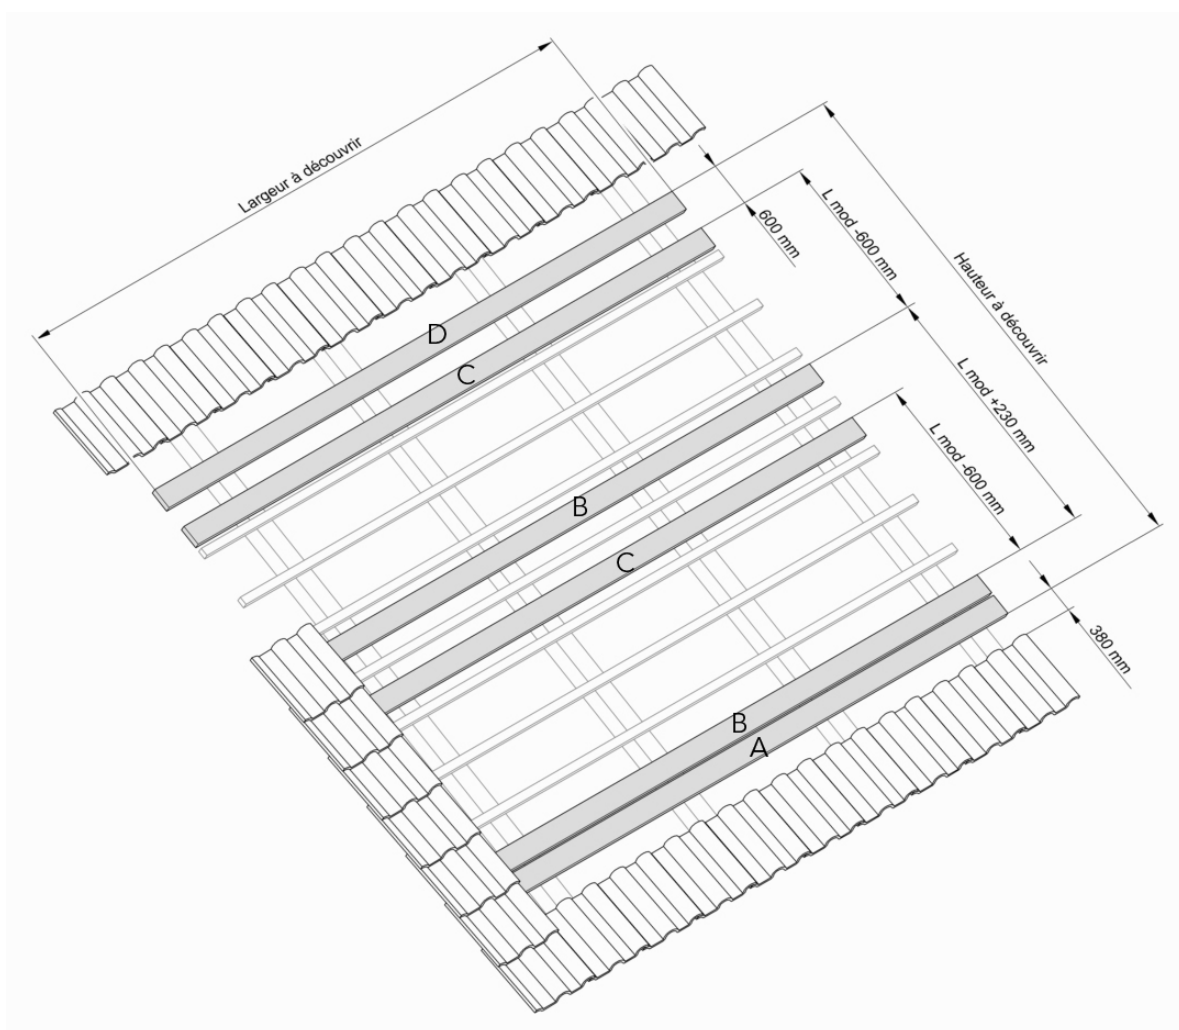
Dimensions de la zone à découvrir et position des planches de 200mm minimum.
